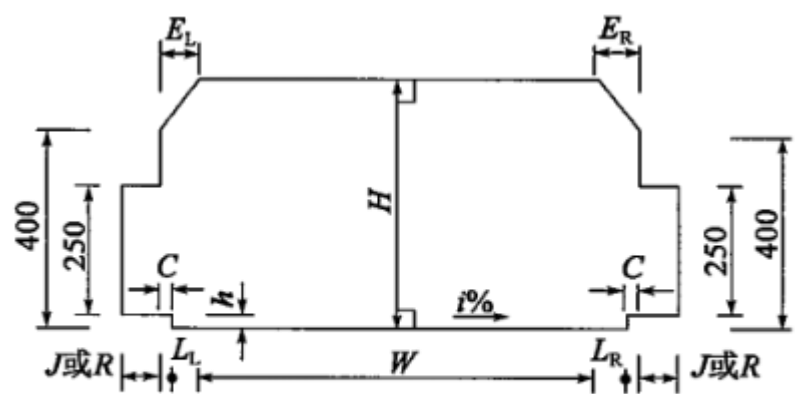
隧道建筑限界(尺寸单位:cm)
